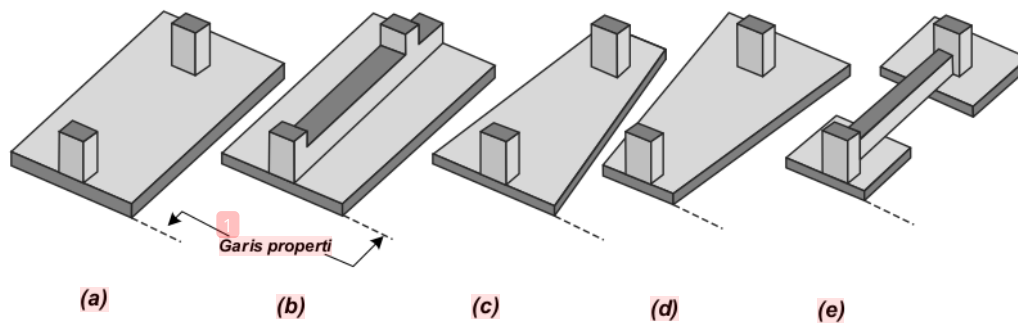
Fondasi tapak untuk dinding terekstensi dengan penggunaan balok sloof.
